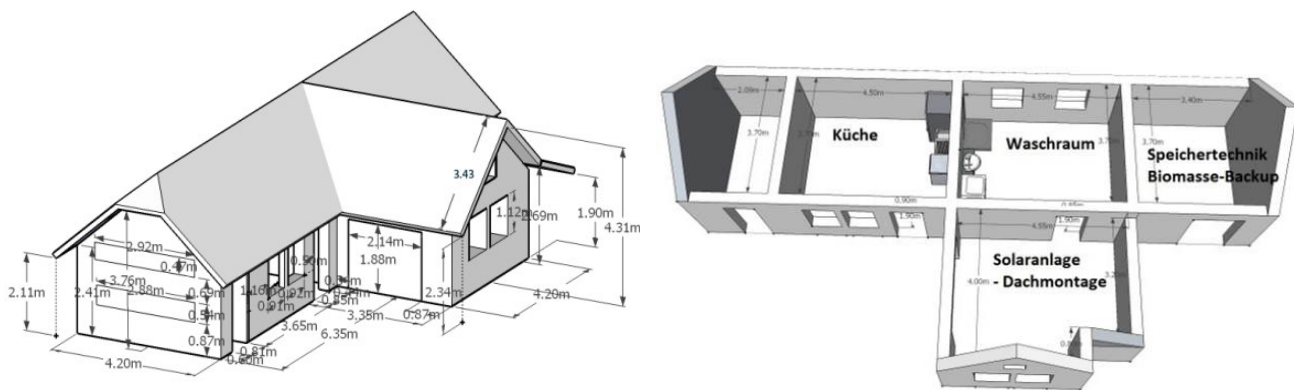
CAD-Profil des Gebäudes für das Prototypensystem (GrAT)
